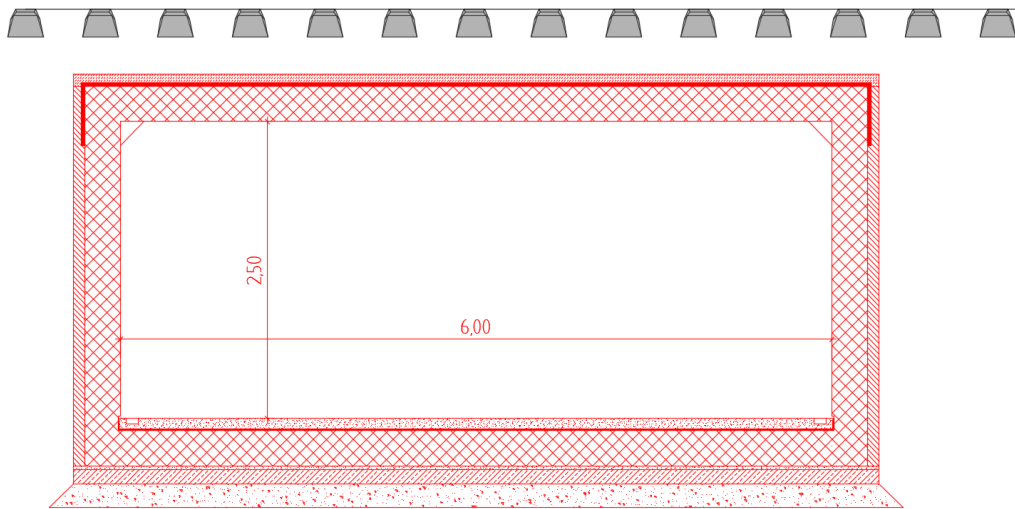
Beispiel Tunnelquerschnitt Geh- und Radwegunterführung
